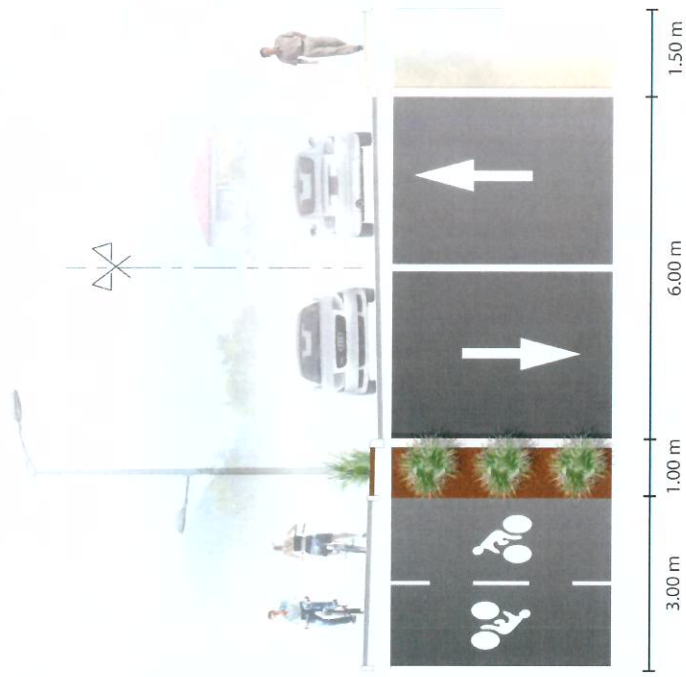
Coupes et profils types de chaussée habillés (Niveau Section courante voie neuve).
